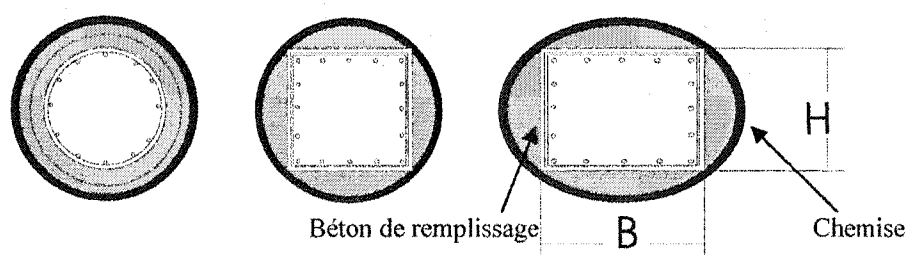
Exemple de renforcement pour les sections circulaires et carrées
